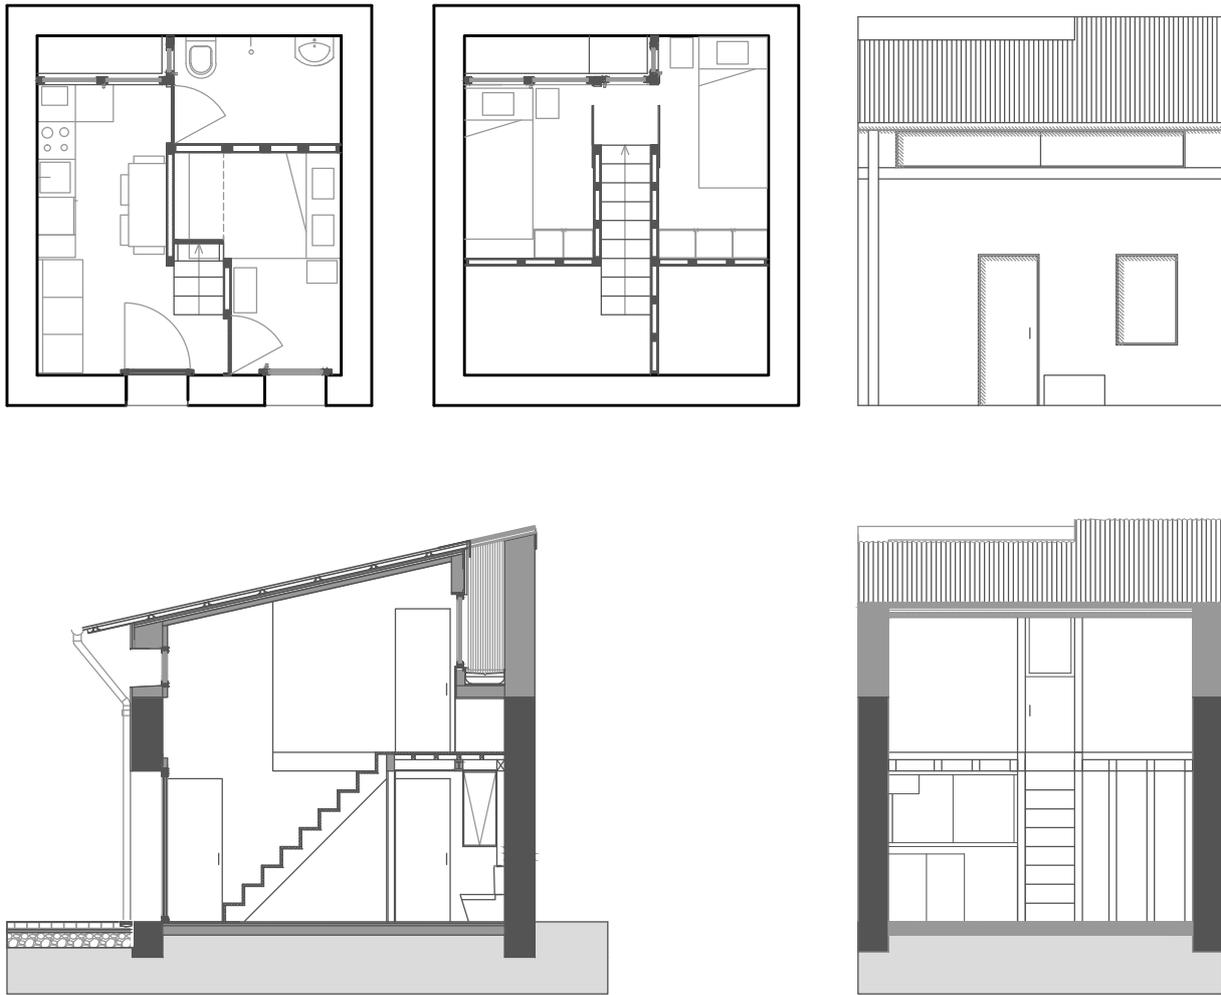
Plantas, Secções e Alçado Tipologia A1 esc. 1:100
